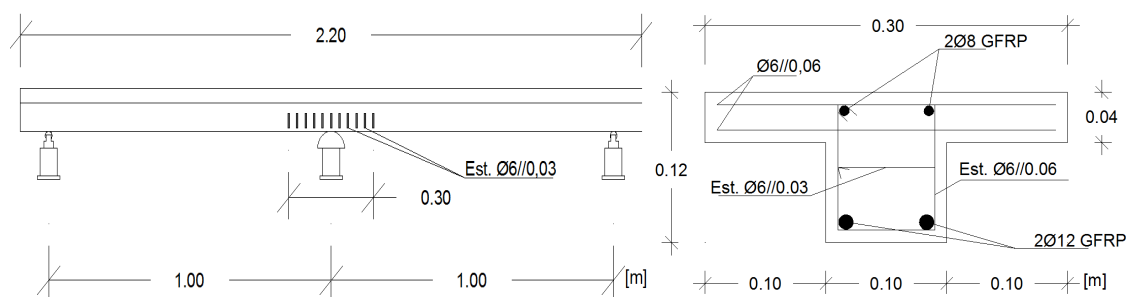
Pormenorização do confinamento do betão na zona central das vigas G3
